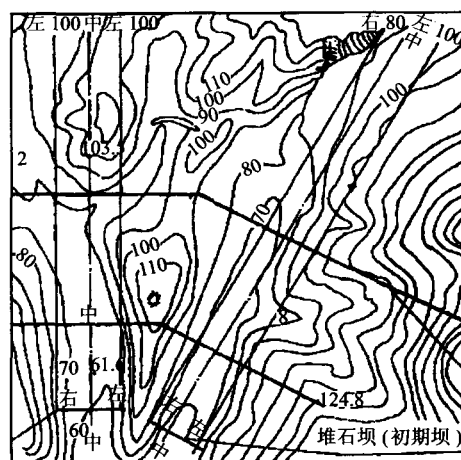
弓长岭选矿厂尾矿库的平面布置图 (单位: m)
